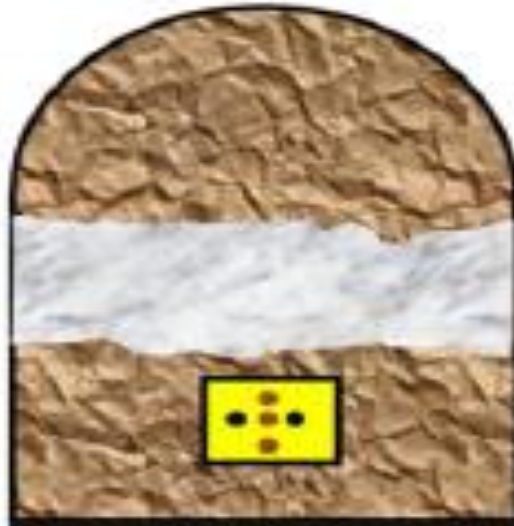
Posición mostrada en el corte debajo de la falla
